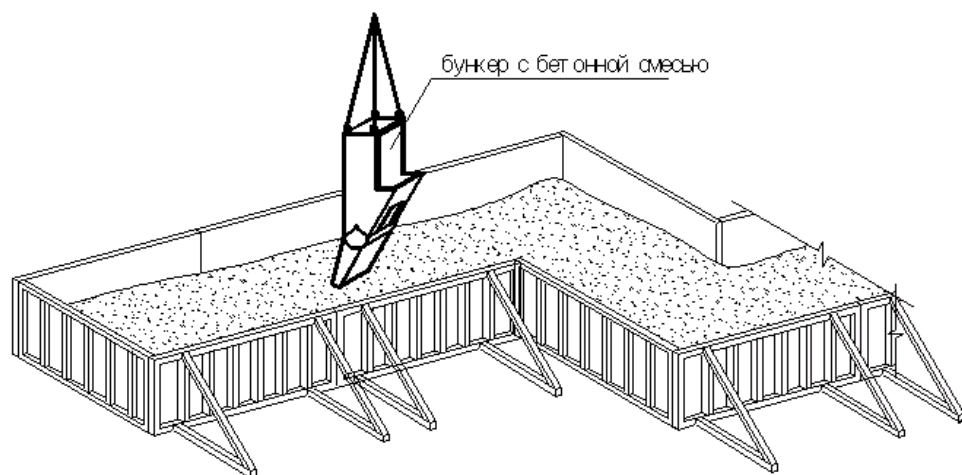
Укладка бетонной смеси в конструкцию методом «кран-бадьа»
